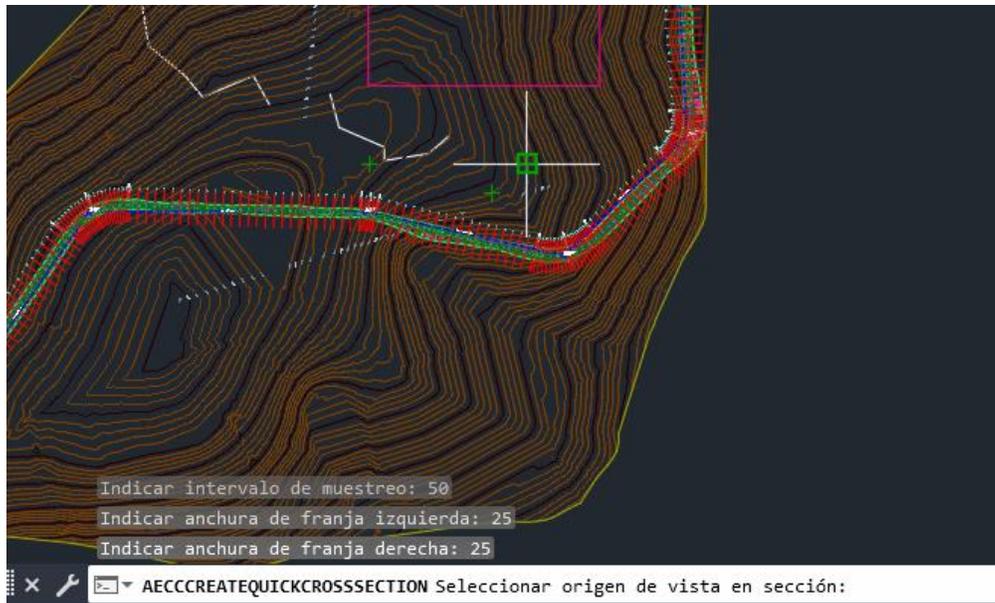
Indicación para seleccionar el punto de origen de la vista de la sección transversal
